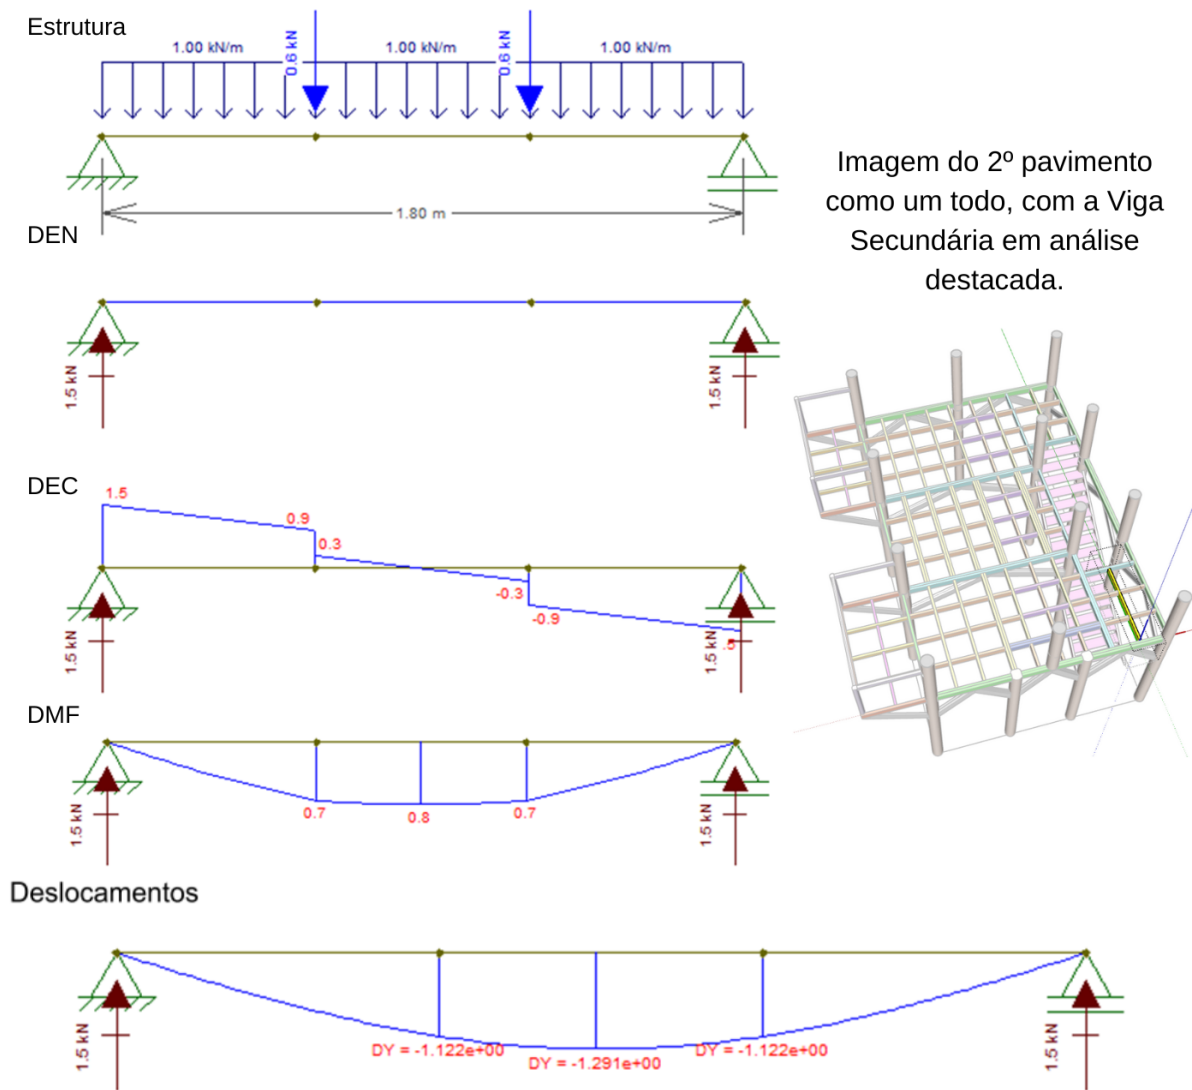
Esquema e análises estruturais das vigas secundárias sem cargas adicionais
